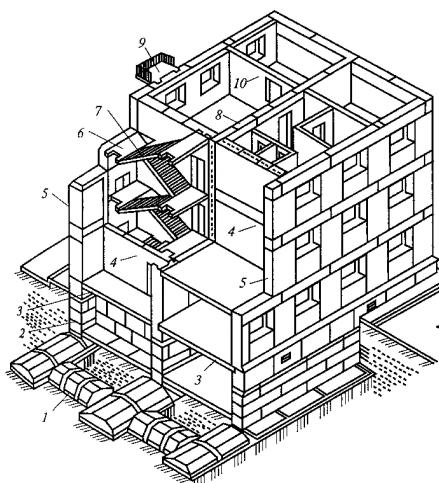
Конструктивная схема крупноблочного здания с продольными несущими стенами: 1 – фундамент; 2 – стены подвала; 3 – перекрытия; 4 – внутренние стены; 5 – наружные стены; 6 – лестничная площадка; 7 – лестничный марш; 8 – внутренняя продольная стена; 9 – балкон; 10 – межкомнатная перегородка
